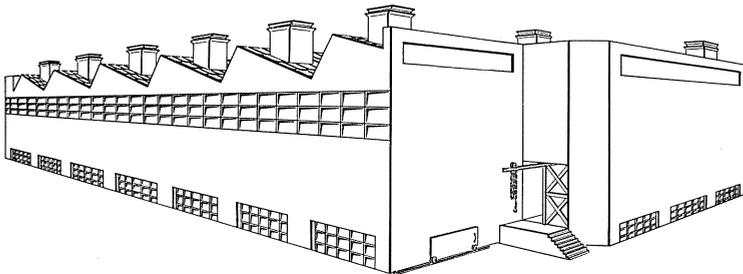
Färbereigebäude, Rückseite mit Laderampe und Salzschüttluke.
